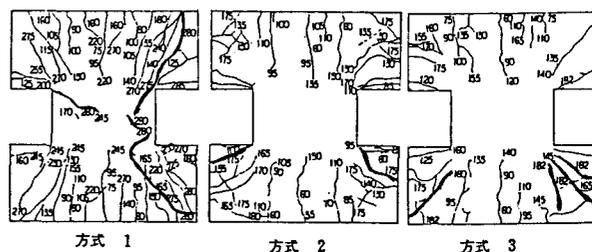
ひび割れ発生図 — 破壊時のひび割れ
